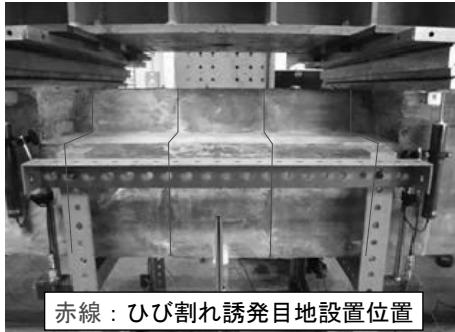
等曲げ区間のひび割れ状況(STEP4)
